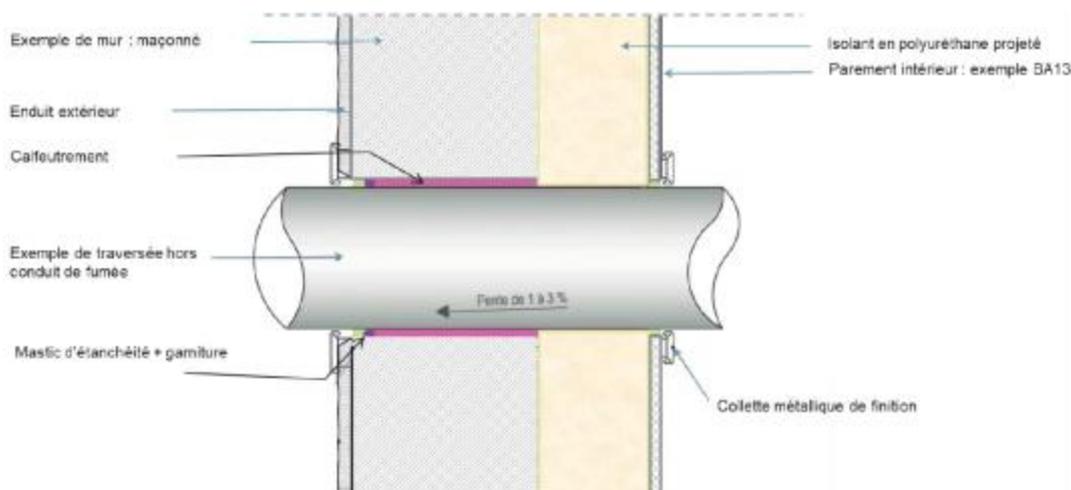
Traversée de murs maçonnés : éléments autres que les conduits de fumées
